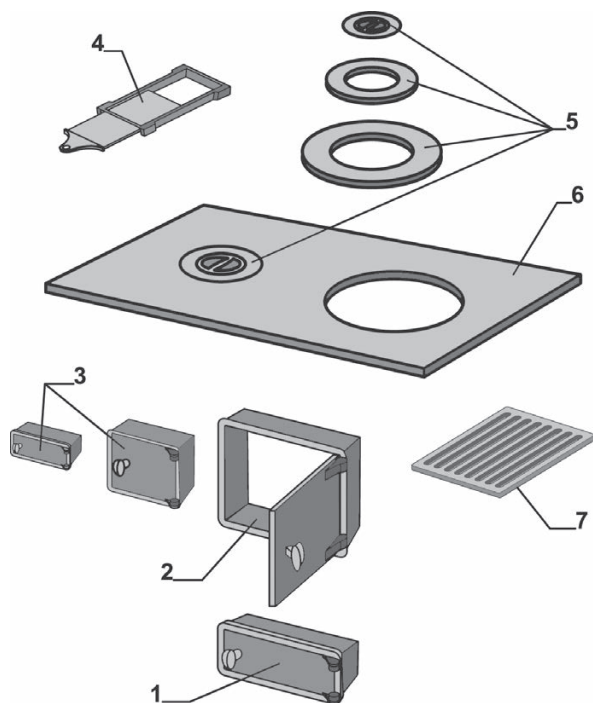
Печные приборы: 1 — поддувальная дверка; 2 — топочная дверка; 3 — прочистные дверки; 4 — печная задвижка; 5 — конфорки; 6 — чугунный настил; 7 — колосниковая решетка
